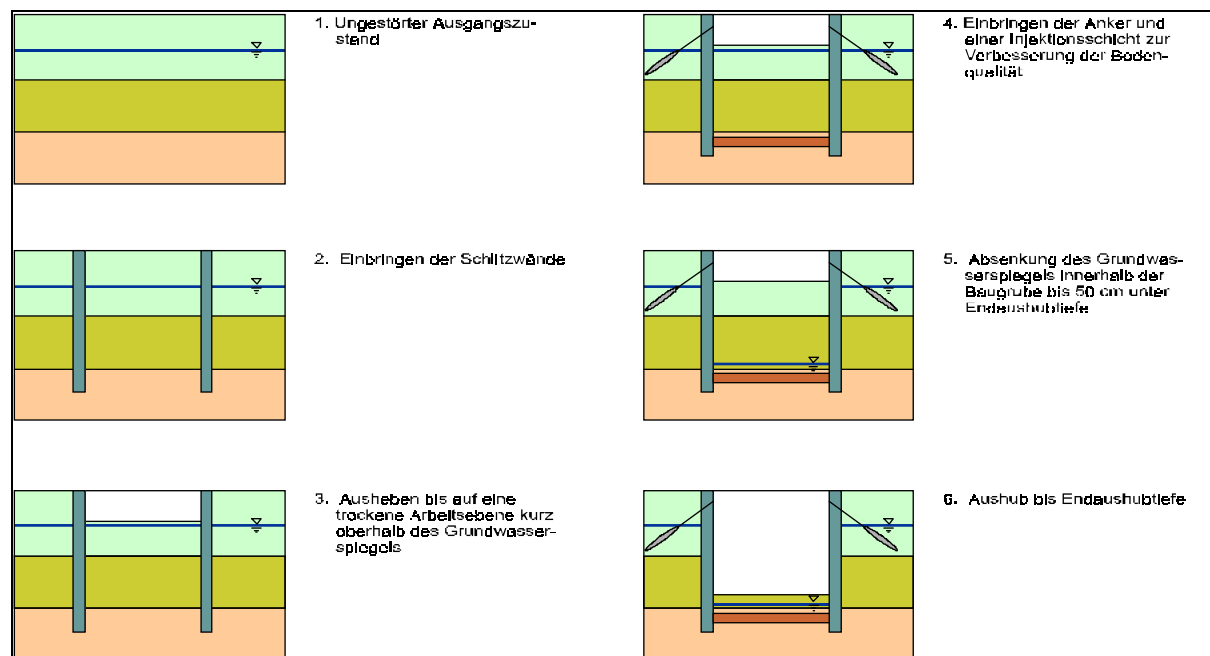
Bauablauf zur Erstellung einer trockenen Baugrube im Grundwasser
